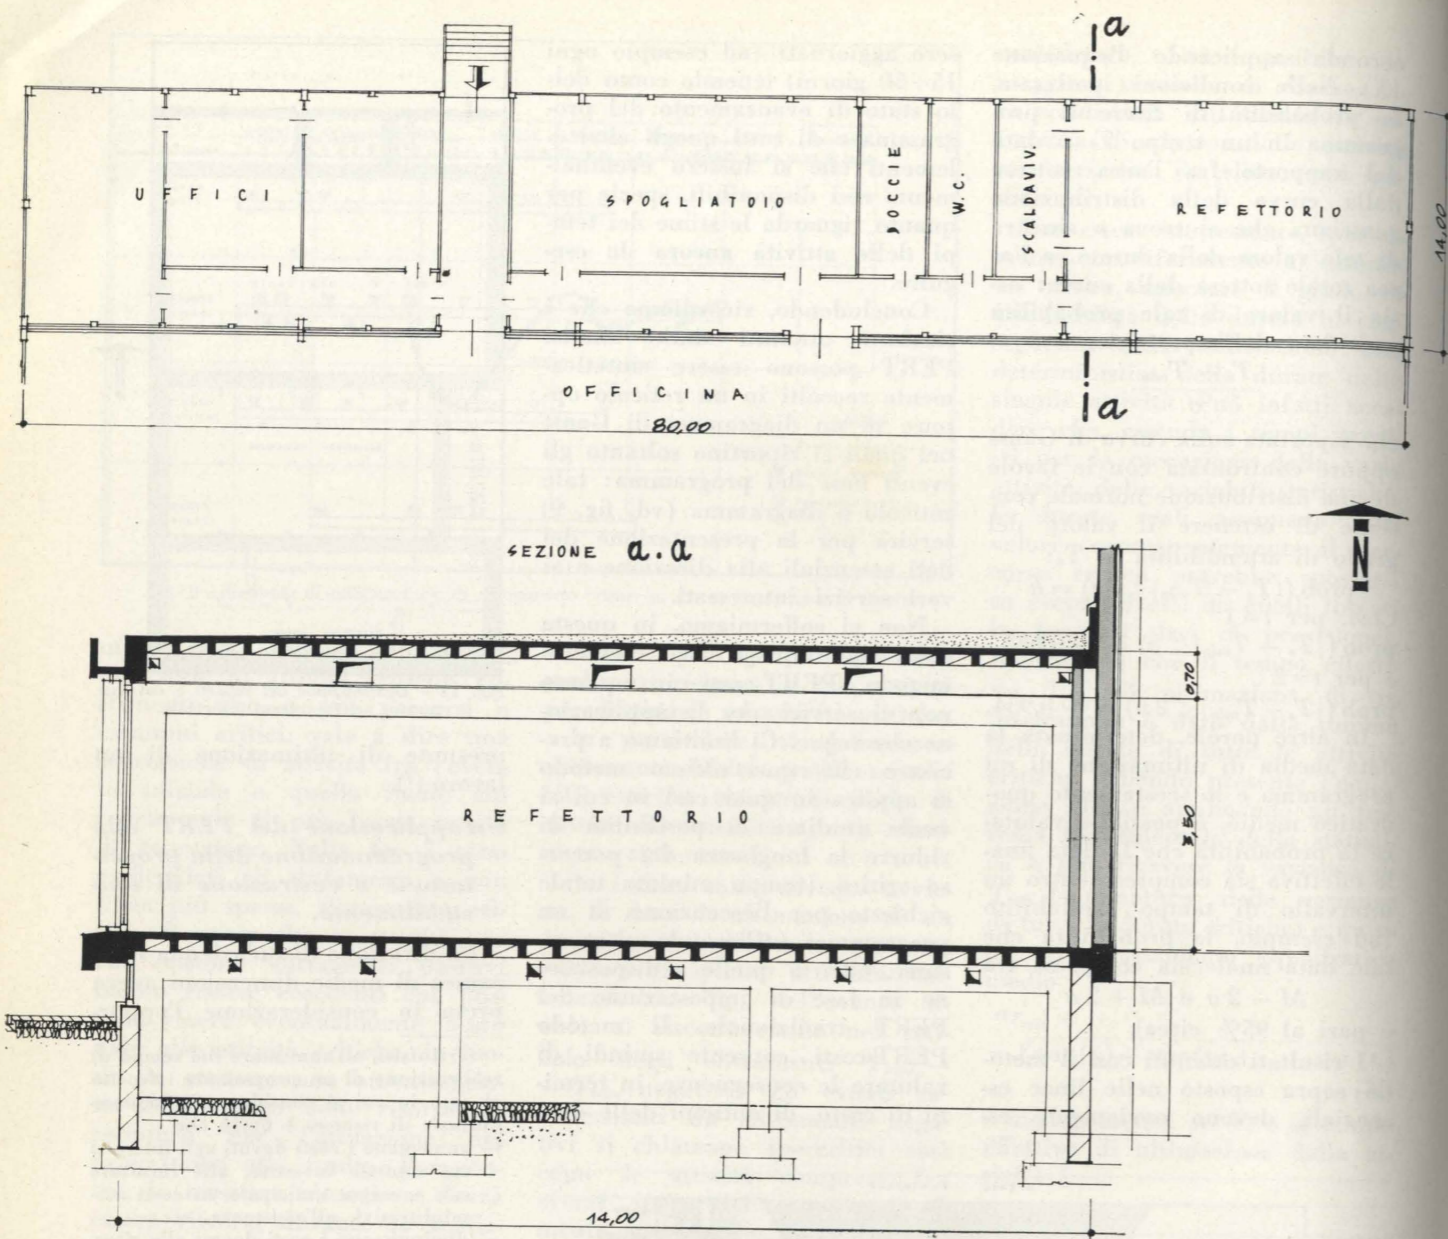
Pianta e sezione dell'avancorpo uffici e servizi.
